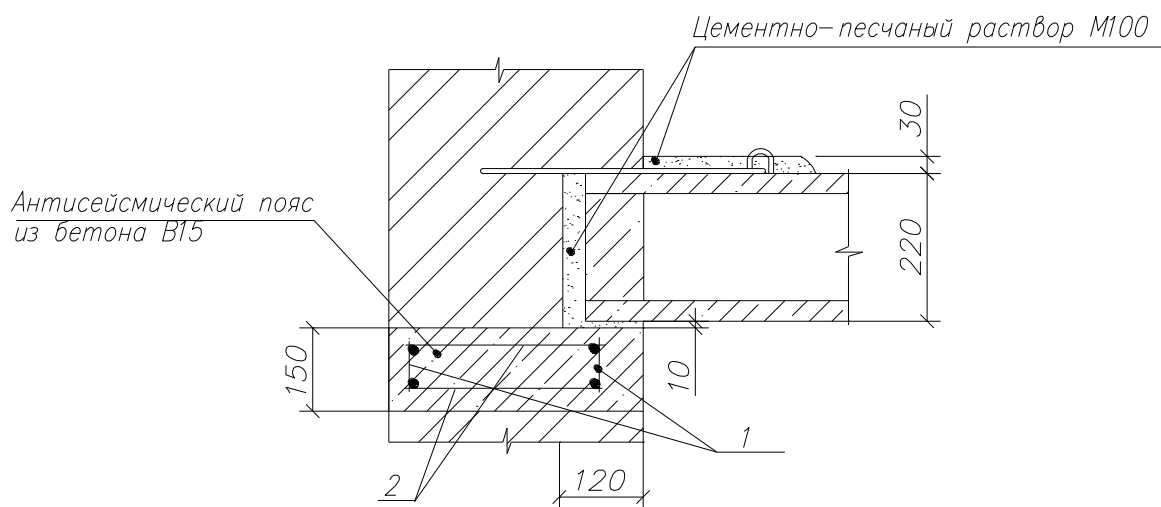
Примыкание панели перекрытия к наружной стене (антисейсмический пояс):
